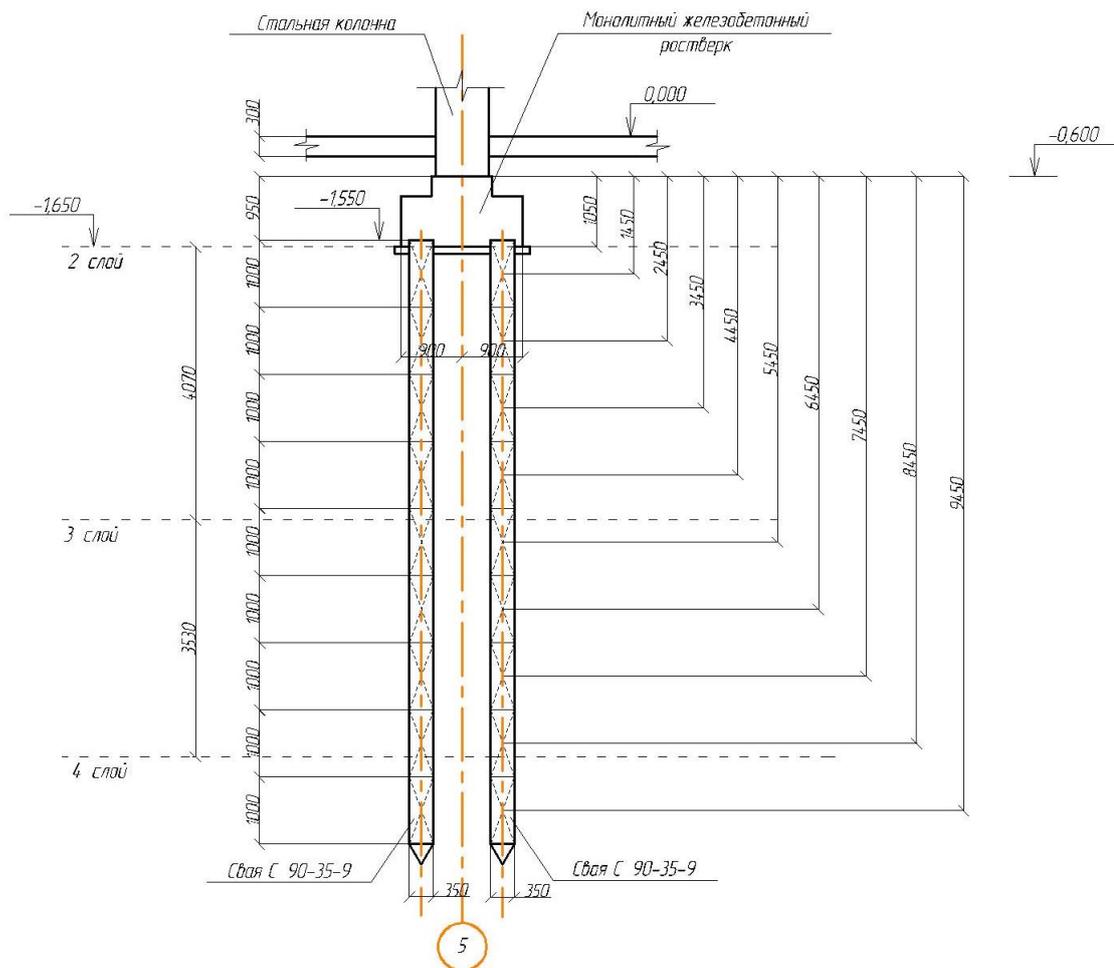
Расчетная схема для определения *i*-го слоя грунта по боковой поверхности сваи
